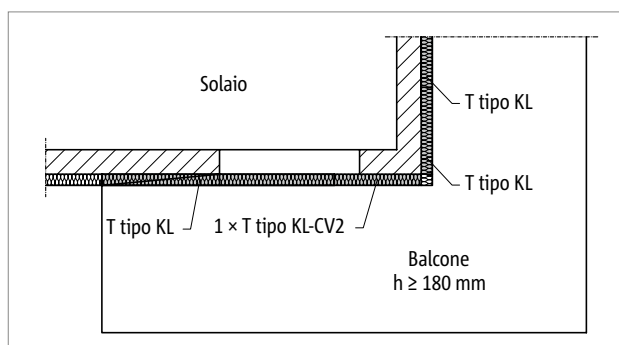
Schöck Isokorb® T tipo KL: balconi ad angolo esterno
